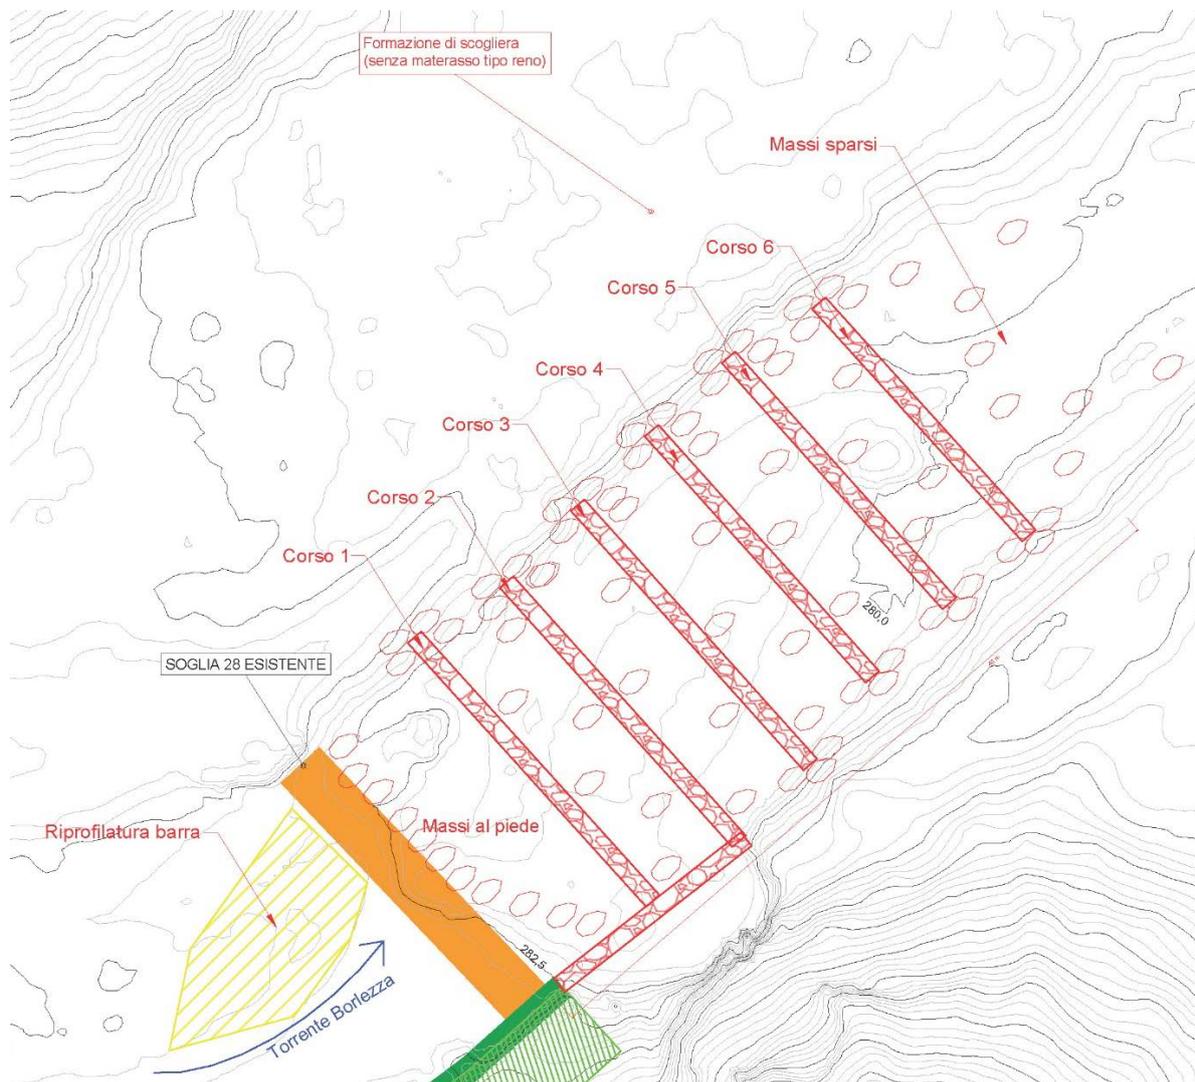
ESTRATTO PLANIMETRIA DI PROGETTO
